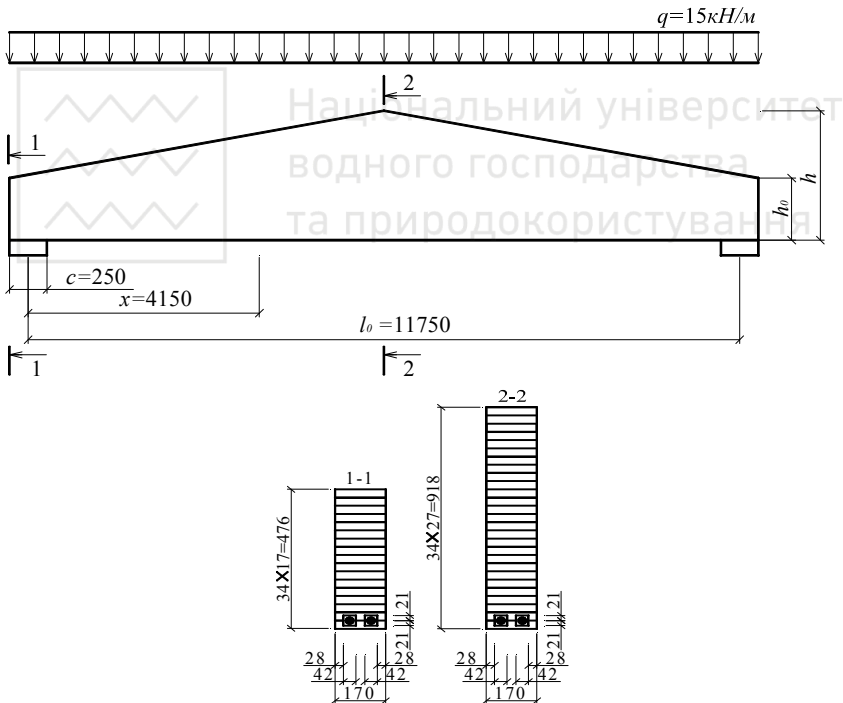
Двоскатна армована дощатоклеєна балка
